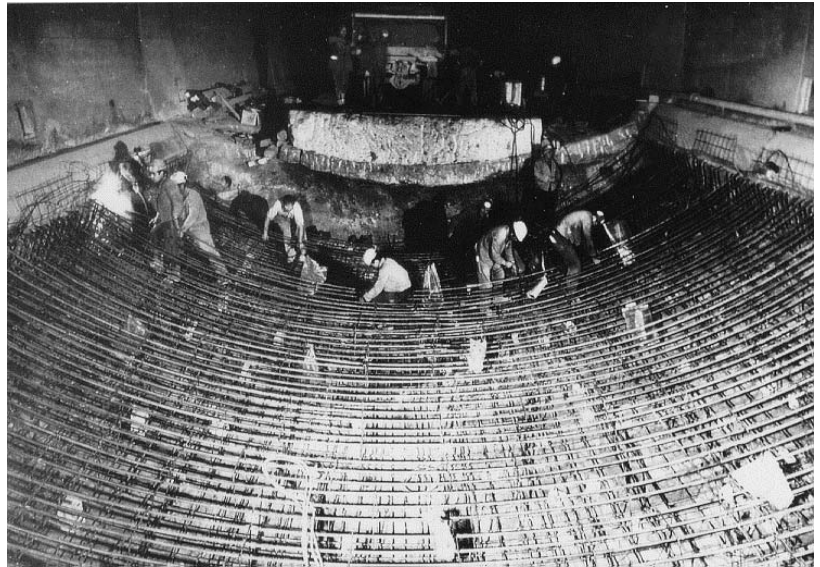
Belchentunnel: Einbau eines 55 cm starken, bewehrten Versuchsgewölbes bei Tm 1.480 im Gipskeuper. Im Hintergrund ist das angehobene, 45 cm starke Sohlgewölbe mit dem darüber liegenden Füllbeton erkennbar (Archivfoto, Kant. Tiefbauamt, Basel-Land).
